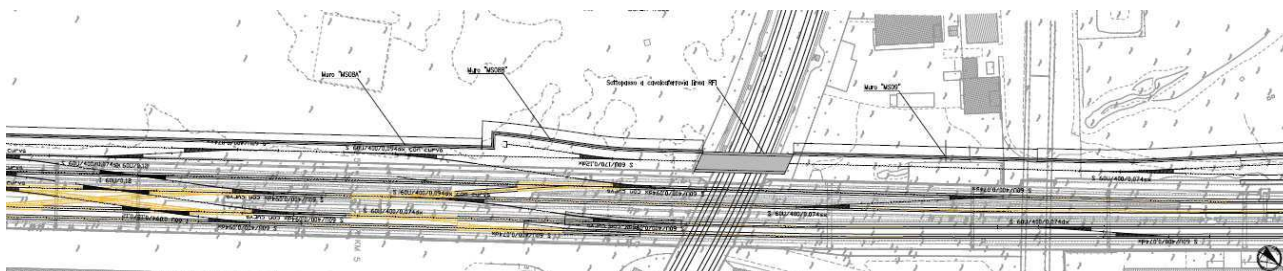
Planimetria di progetto (sottopasso a cavalcaferrovia RFI)
